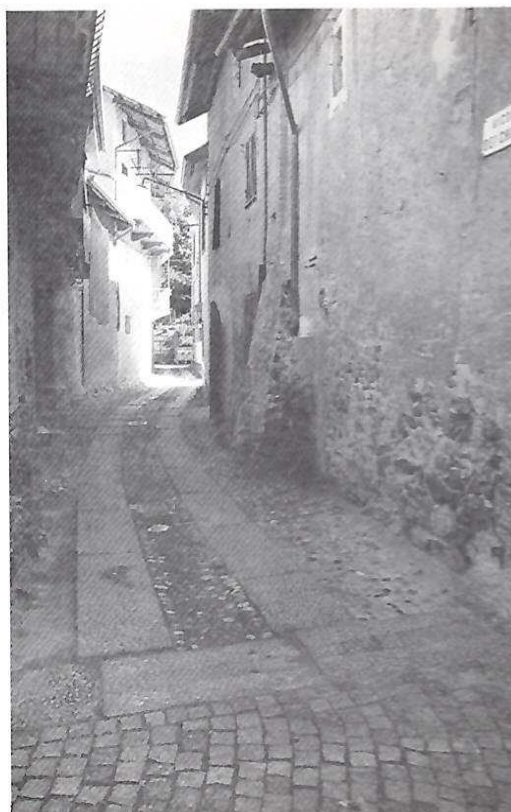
Pavimentazione originaria in acciottolato con guide e nuova pavimentazione in selciato (Via Roma).
